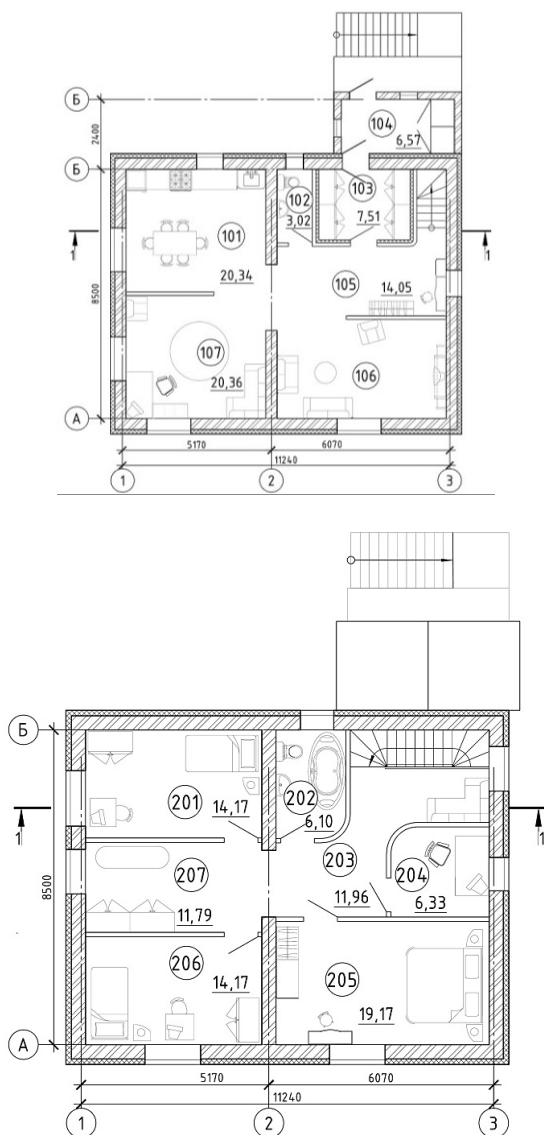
Планы 1-го и 2-го этажей жилого здания
